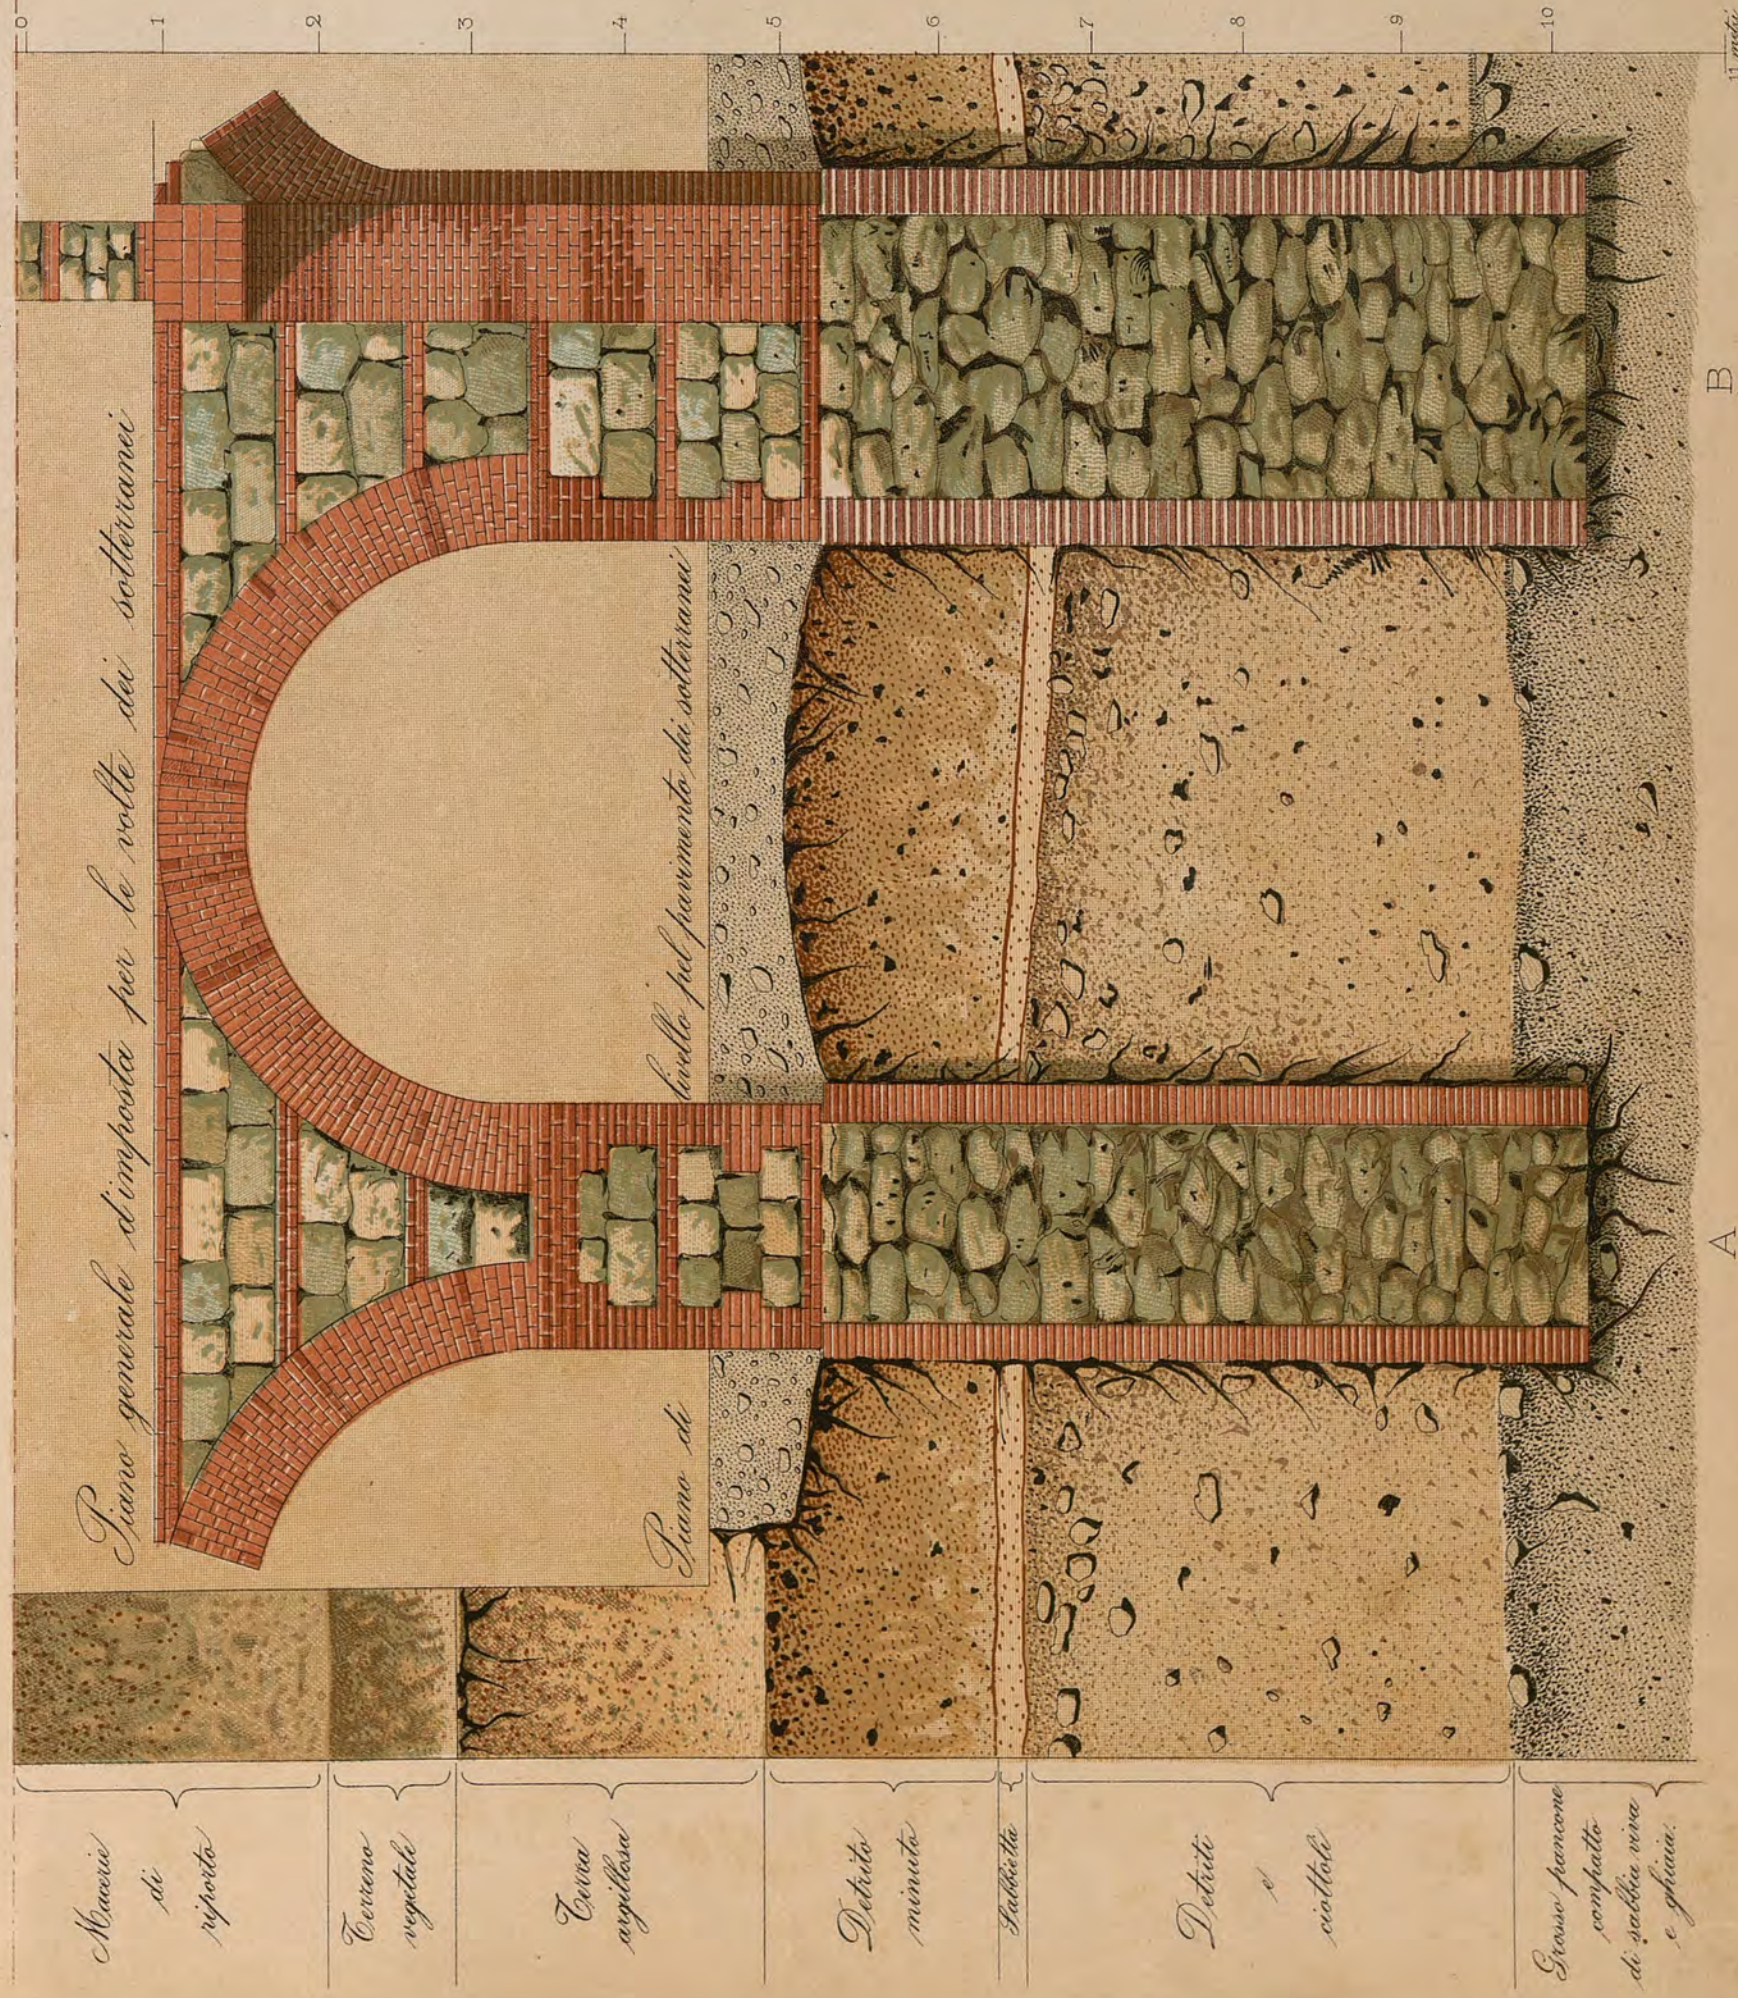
L'arricchimento dello scavo pel pozzo di fondazione e la costruzione della gola in muratura
